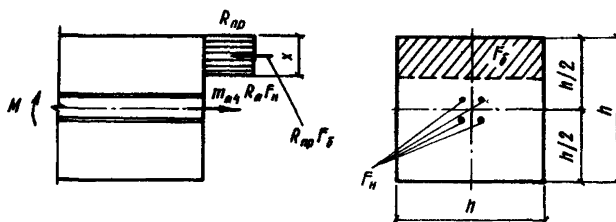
Рис. I. Схема усилий и эпюра напряжений в сечении, нормальном к продольной оси изгибаемой железобетонной сваи, при расчете ее по прочности
